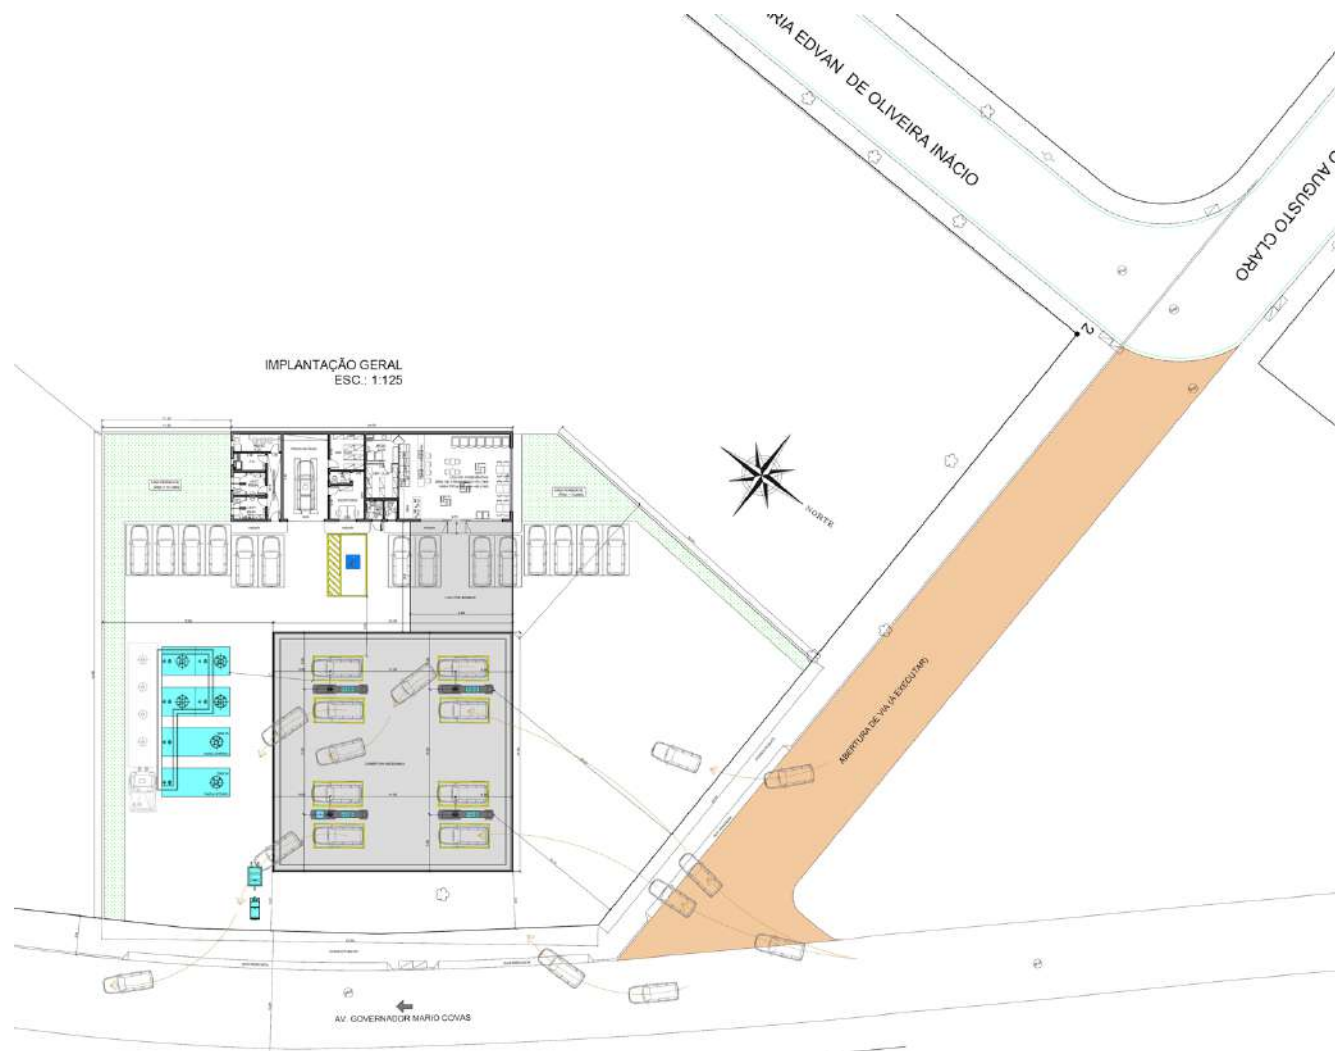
Planta proposta para a instalação do Auto Posto Malásia.
